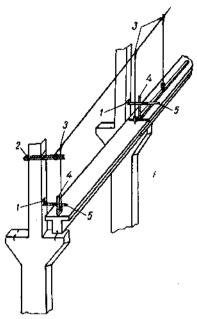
Схема укладки и выверки подкрановых балок и рельсов: 1 – риски на одной отметке на всех колоннах (не выше 20 см отметки головки рельса); 2 – кронштейн для натяжения проволоки (струны); 3 – отвесы; 4 – миллиметровая линейка для измерения расстояний от грани балки и головки рельса до рейки; 5 – небольшая рейка с монтажным уровнем
